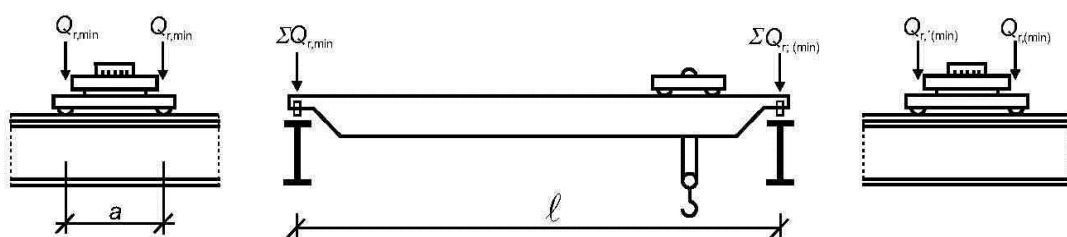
Распределение нагрузки крана без груза на крюке с целью достижения минимальной нагрузки на балку подкранового пути
